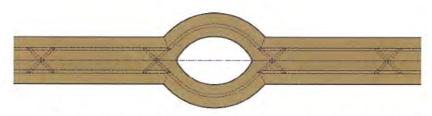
Vista en planta distribución de columnas con abertura ovalada.
